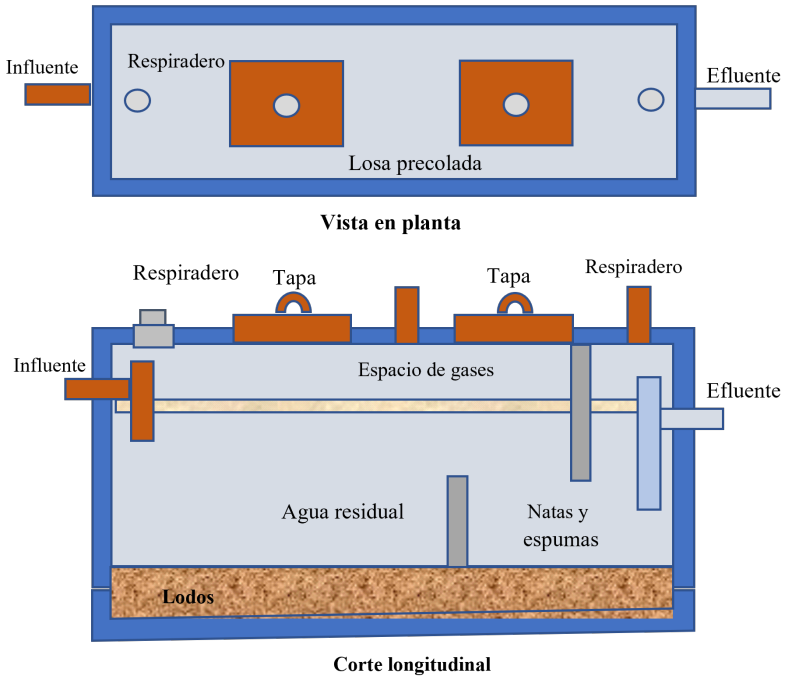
Corte longitudinal y vista en planta del tanque séptico.
